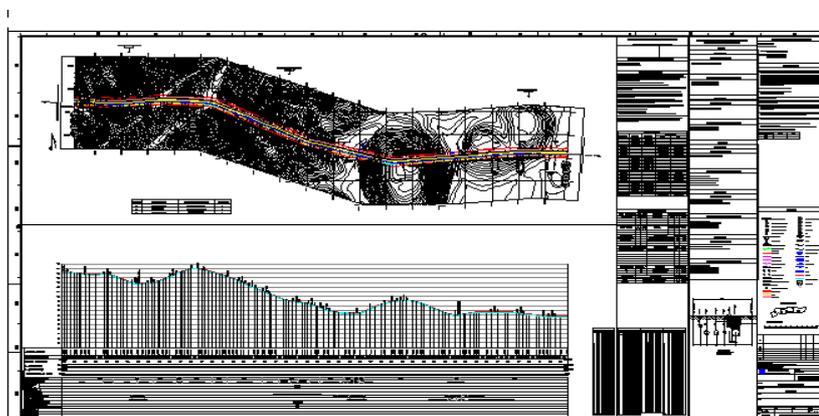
Desenho de Planta e Perfil de um Gasoduto
